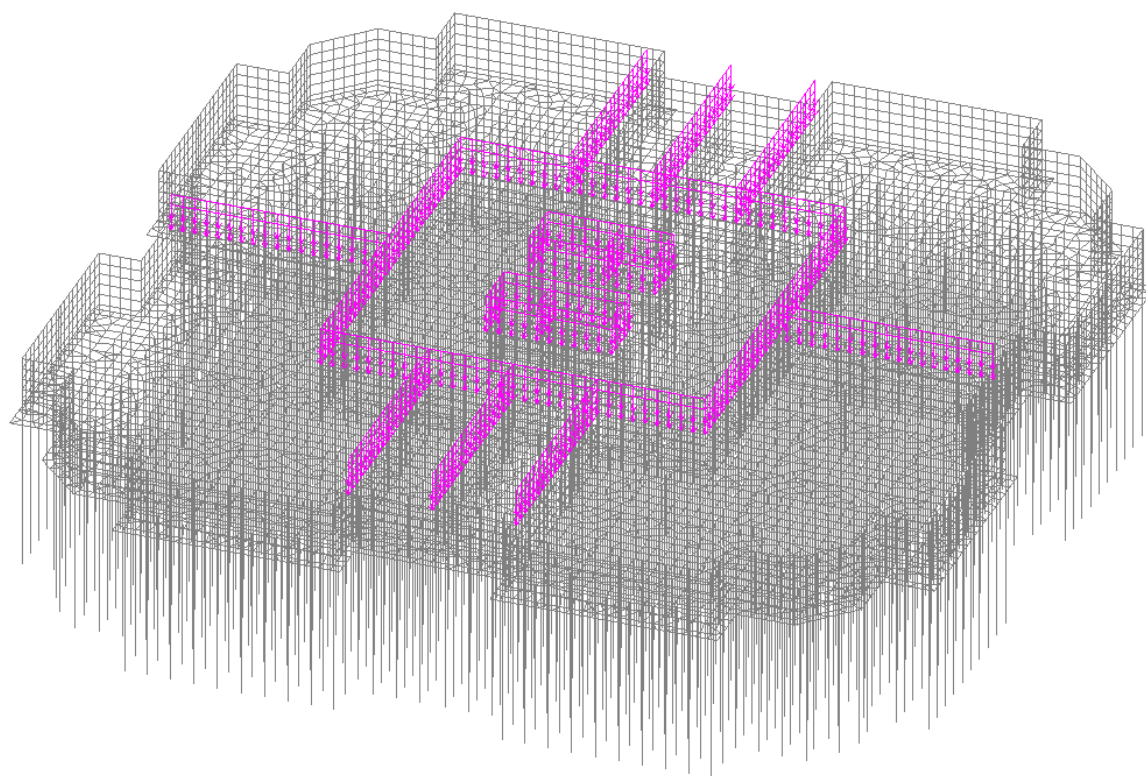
Схема приложения нагрузки на внутренние стены
